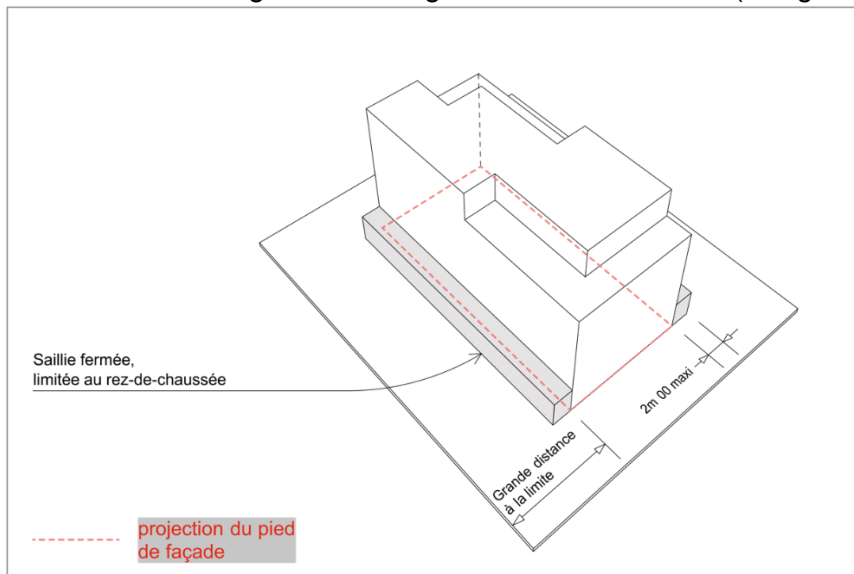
jusqu'à présent : élément de construction saillant fermé, limité au rez-de-chaussée (rouge : modifications par rapport au croquis existant)
